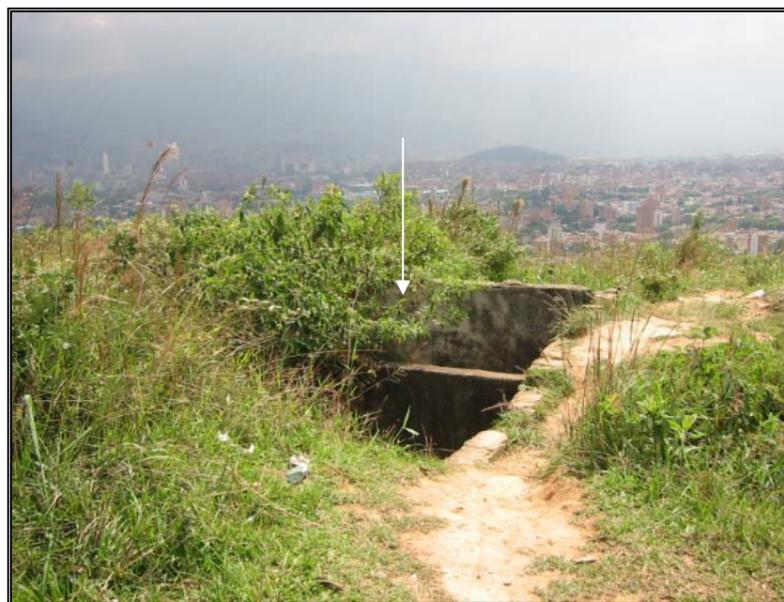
Tanque desarenador para las aguas de lavado, evacuadas a través del Zanjón El Coco, Coordenadas (N6 16 15.6 W75 36 11.7) 1667 msnm.
